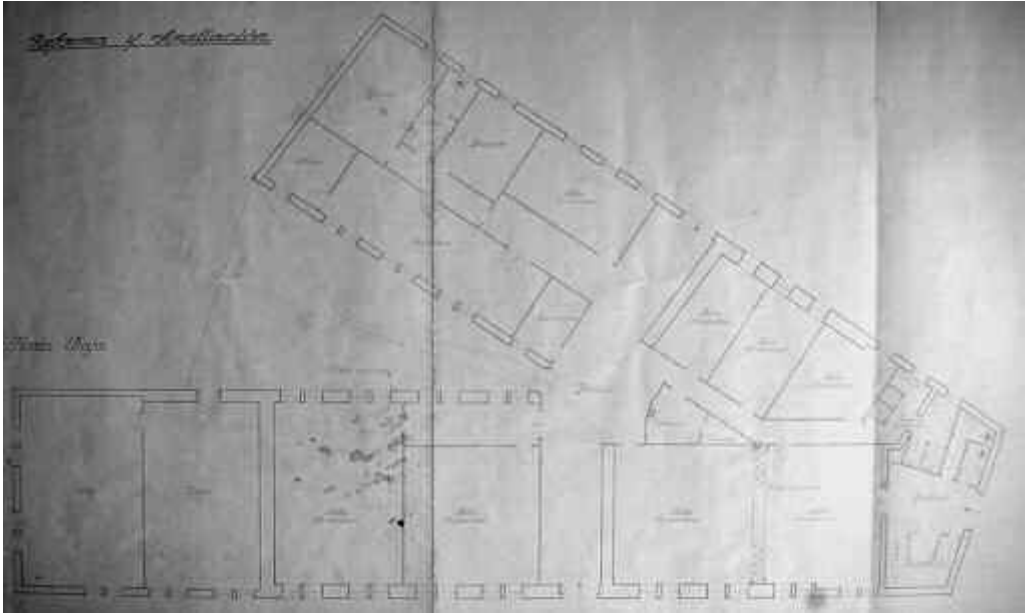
Joaquín Vaquero: Planta baja del proyecto de Reforma y ampliación, junio de 1945.
